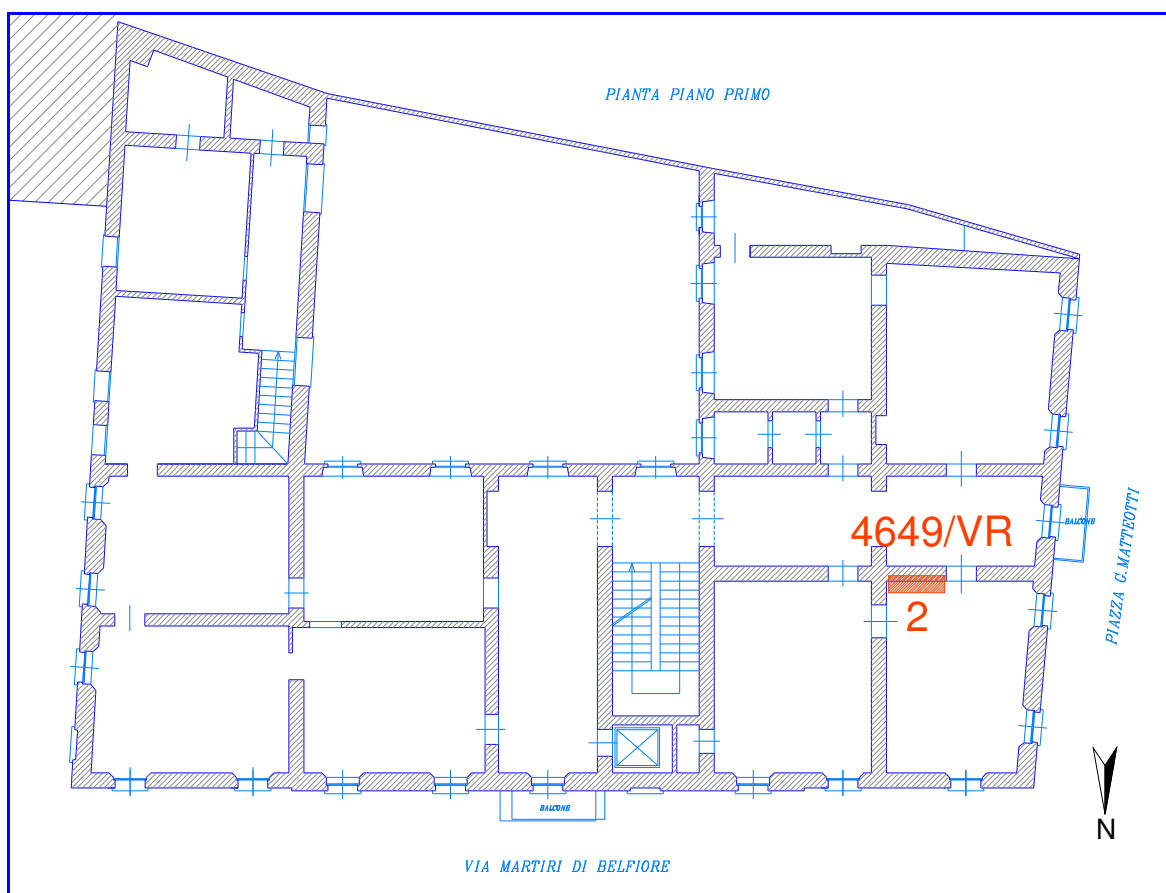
Planimetria del piano primo con ubicazione della zona indagata
